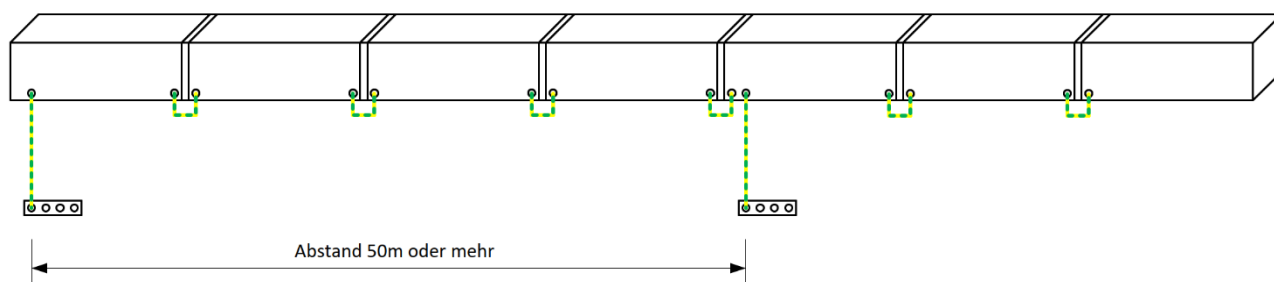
Conduit de ventilation avec liaison équipotentielle
